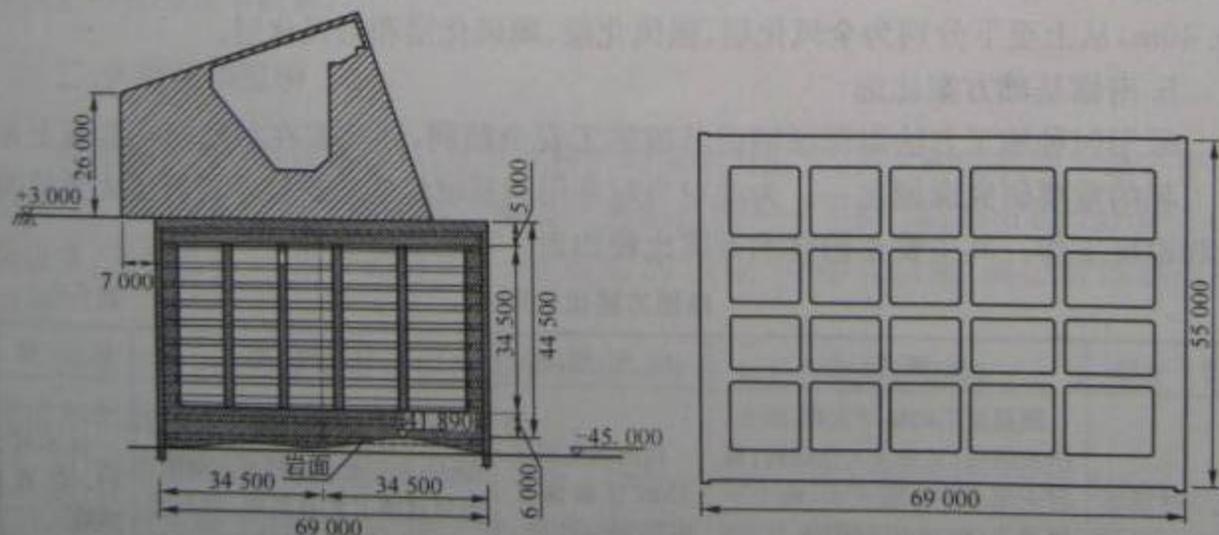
矩形地连墙基础方案总体布置图(尺寸单位:mm)
